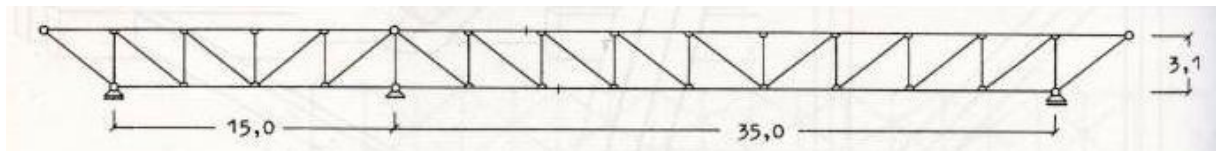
statisches System Fachwerk [Alois Mucha Holzbrücken S.120]
